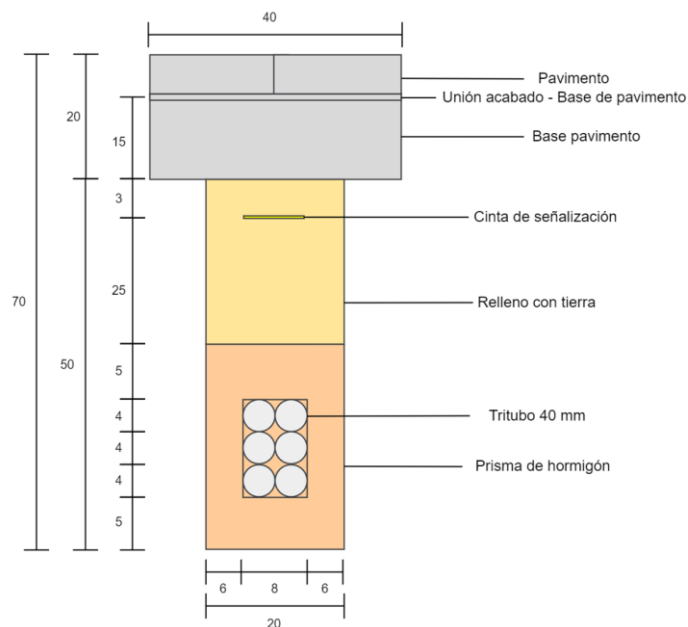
Minizanja con dos tritubos (6c40 mm) por acera
